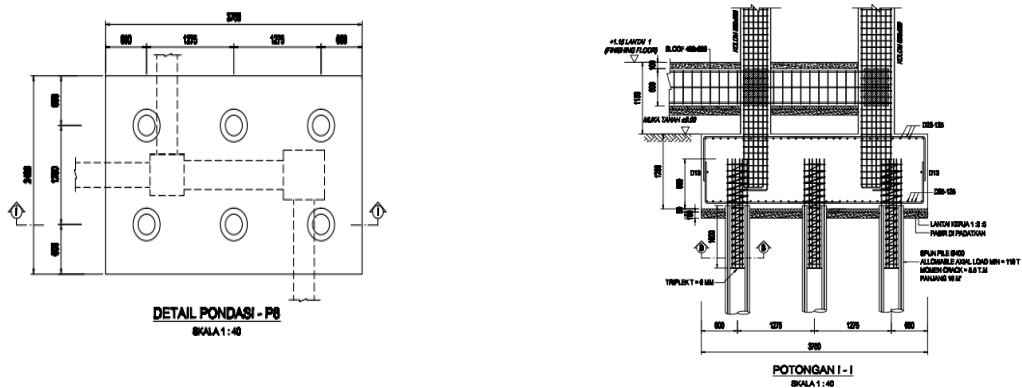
(a) Pondasi 6 Tampak Atas (b) Pondasi 6 Tampak Samping
